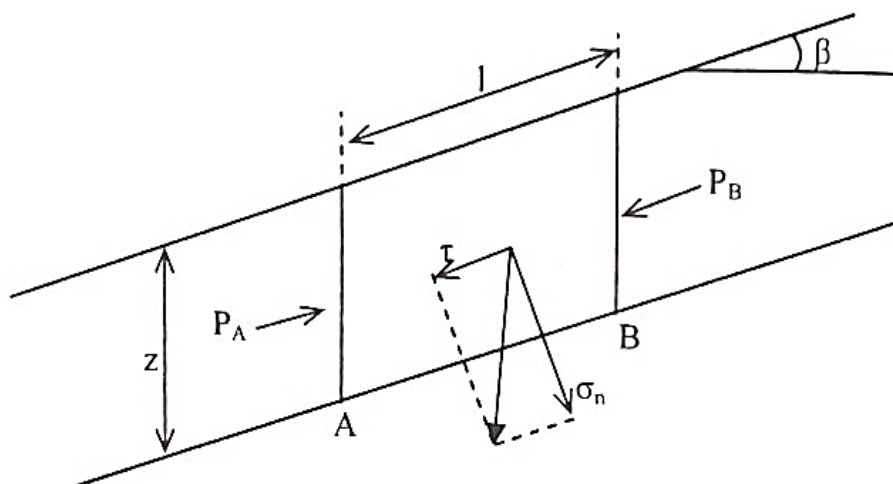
Cas d'un glissement plan avec une longueur infinie [24]
